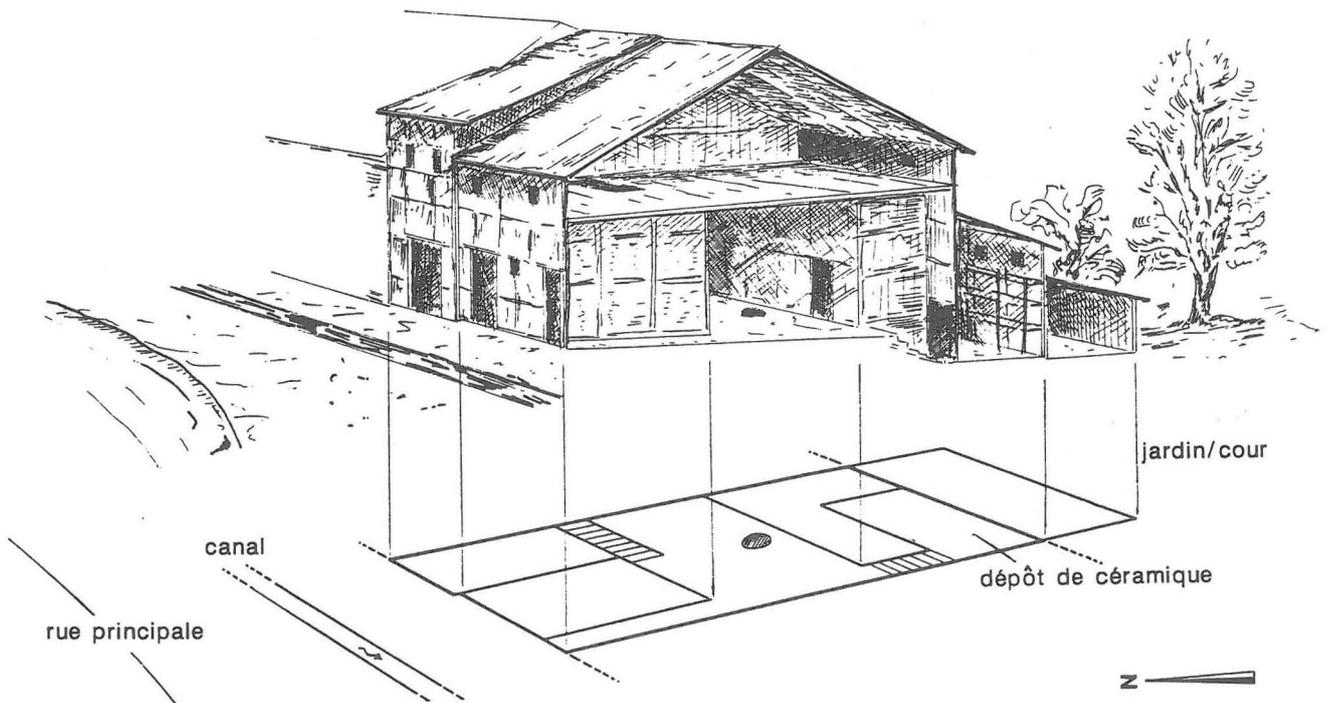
Plan et reconstruction de la maison dans laquelle se trouvait le dépôt (dessin : P. Albertin, Winterthur/Suisse).
